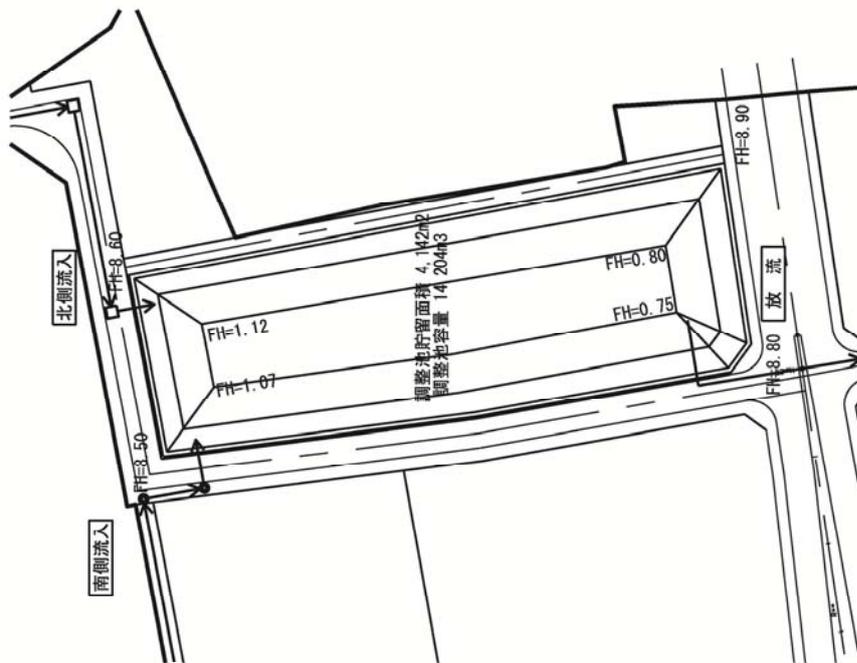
(2) 調整池計画平面・断面図 (第1調整池) 【変更後】
